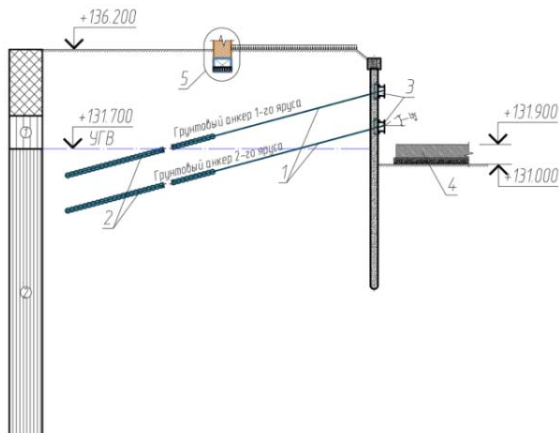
Характерный разрез ограждения котлована: 1, 2 – грунтовые анкера ЭРТ первого и второго уровня; 3 – стальные анкерные пояса;
